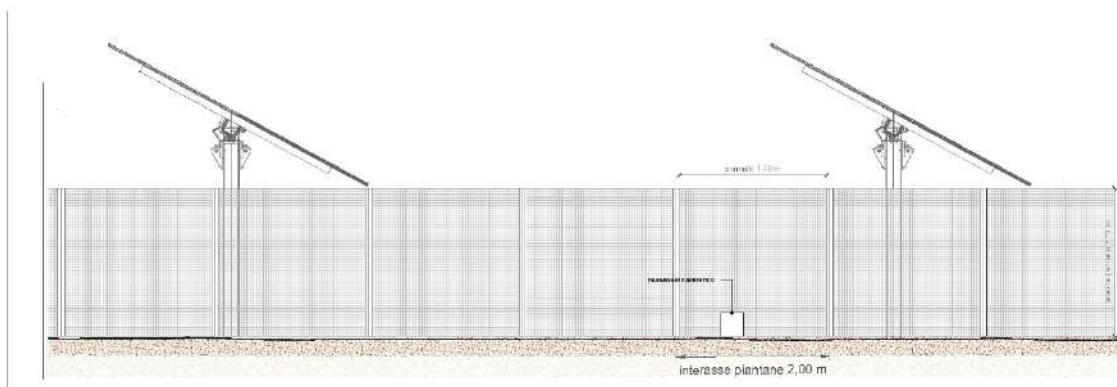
Prospetto recinzione perimetrale senza mitigazione
